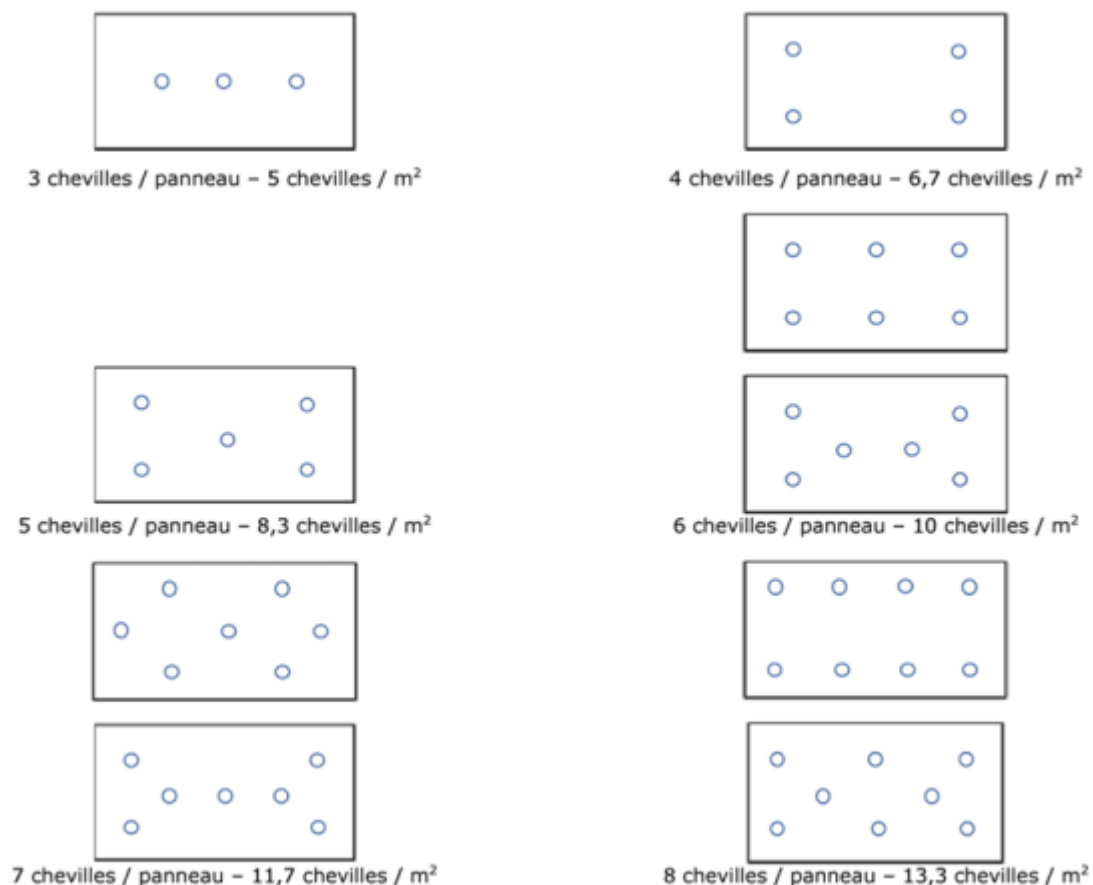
Plans de chevillage - panneaux de dimensions 1000 x 600 mm – Chevillage en plein - (espacement entre chevilles ≥ 100 mm et distance au bord ≥ 100 mm)
